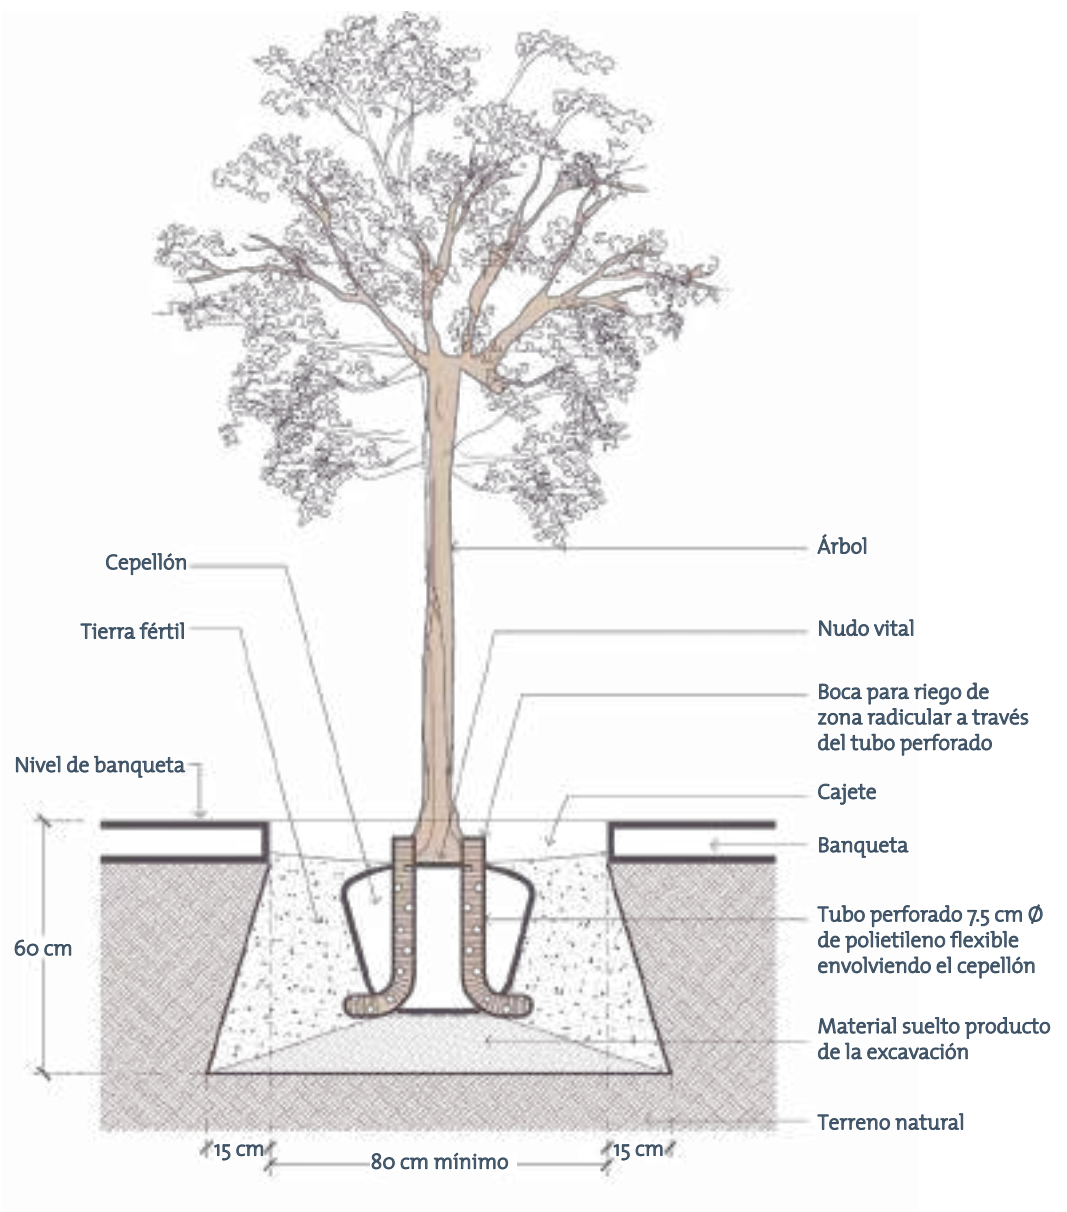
Riego de árboles en áreas pavimentadas mediante tubos o mangueras perforadas
